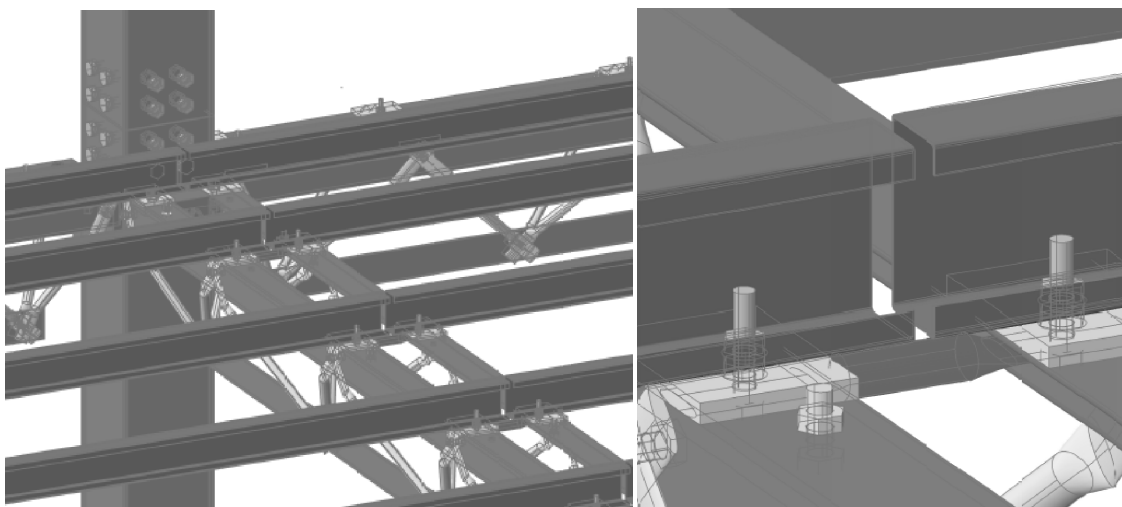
Exemplificação da ligação das vigas de piso em módulos dispostos consecutivamente
